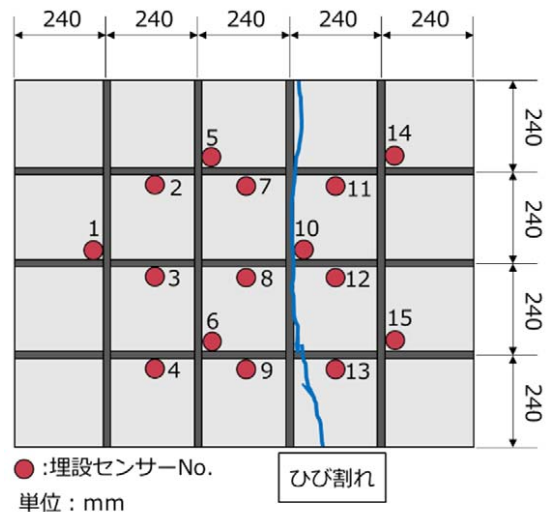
試験体寸法, センサ埋設位置, ひび割れ位置
